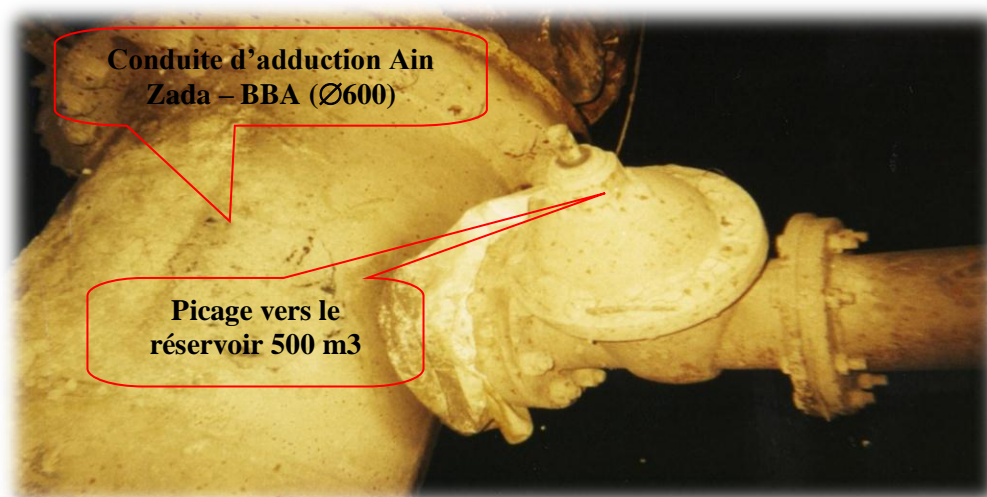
Piquage sur la conduite d'adduction Ain Zada – BBA.
